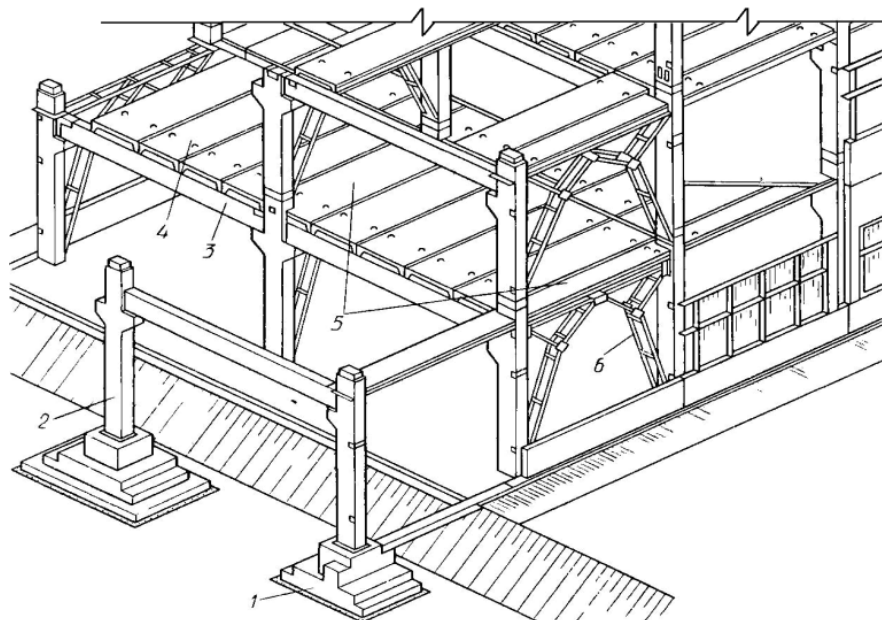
Железобетонный каркас многоэтажного промышленного здания:
